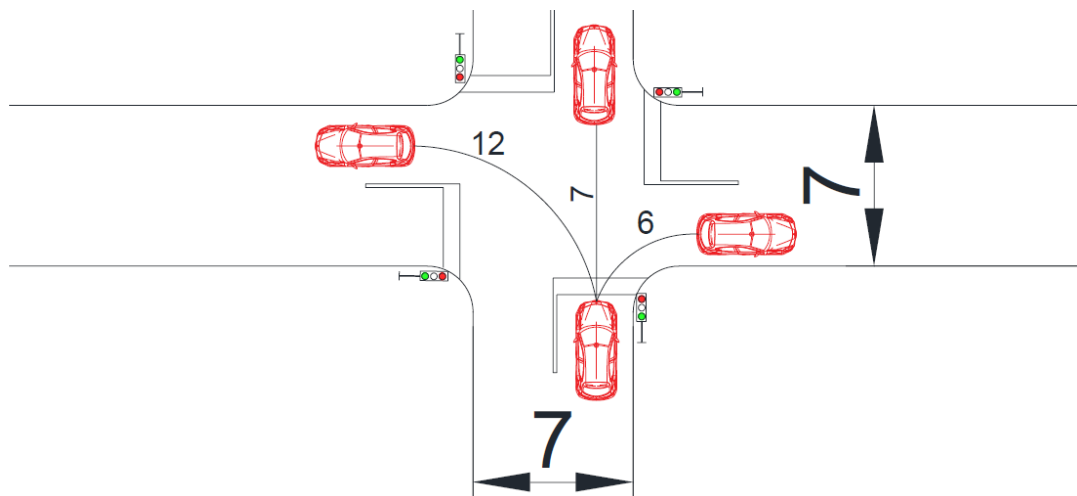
raffigurazione CAD di un'intersezione tipo e con la traiettoria seguita dall'autovettura oggetto di test.
